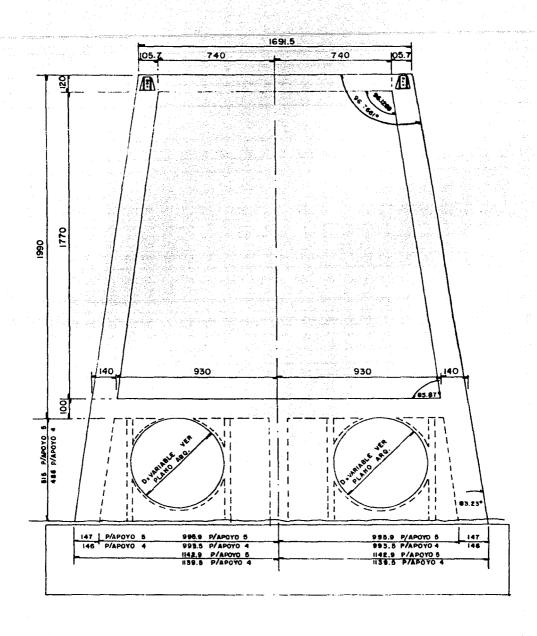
VISTA DEL APOYO - MASTILES CONCLUIDOS.
